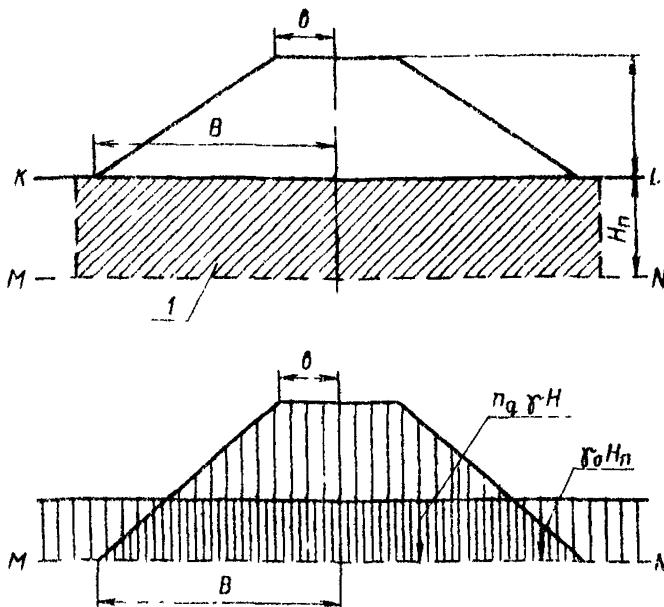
Схема нагрузок к расчету глубины замены грунта:
